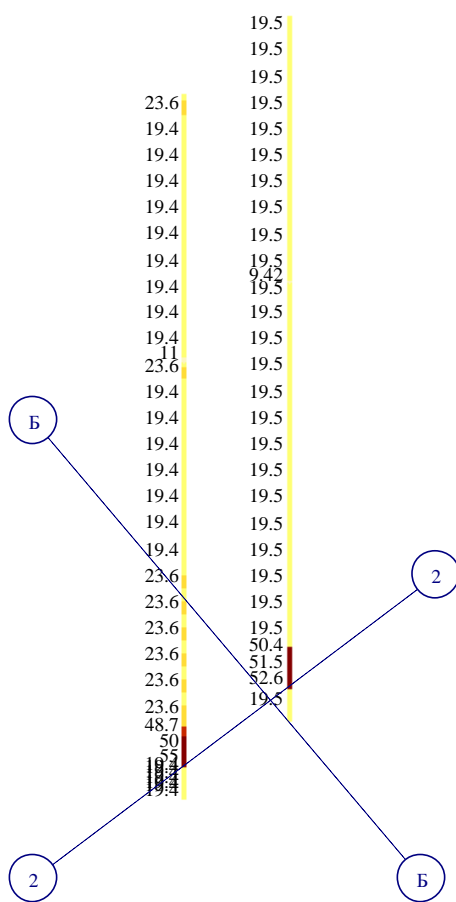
Площадь армирования колонн осях А/2 и Б/2 без дополнительной нагрузки
